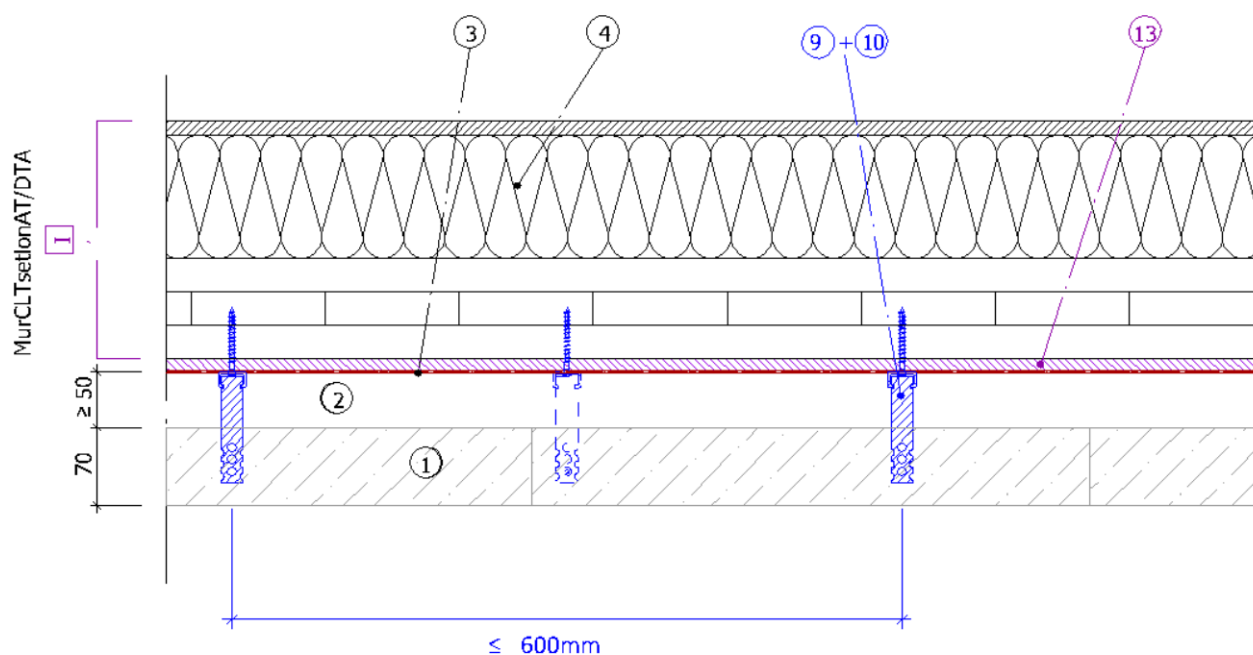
Panneaux structuraux massifs bois – Coupe horizontale – écran thermique en plaque
